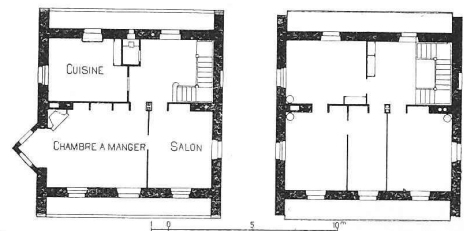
Maison de Madame Clerc aux Hauts-Geneveys. Plan du rez-de-chaussée et du 1<sup>er</sup> étage. — Echelle 1 : 400.
